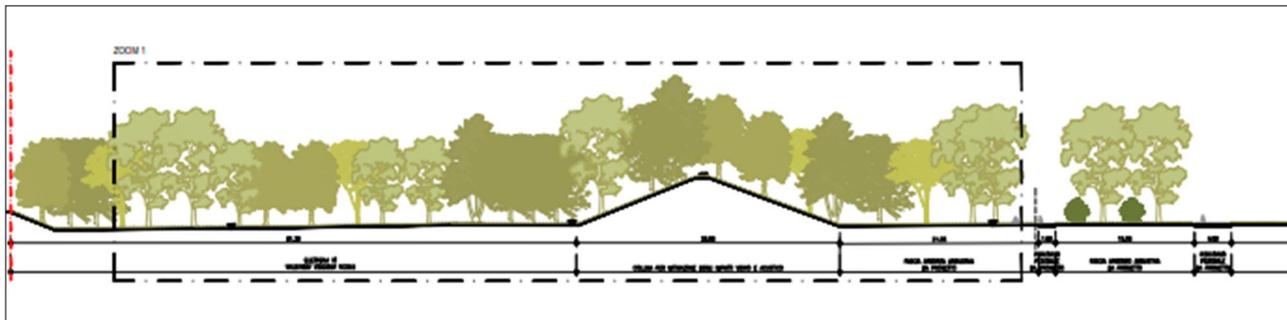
Stralcio da elaborato AUA1883 su sezioni di progetto.
